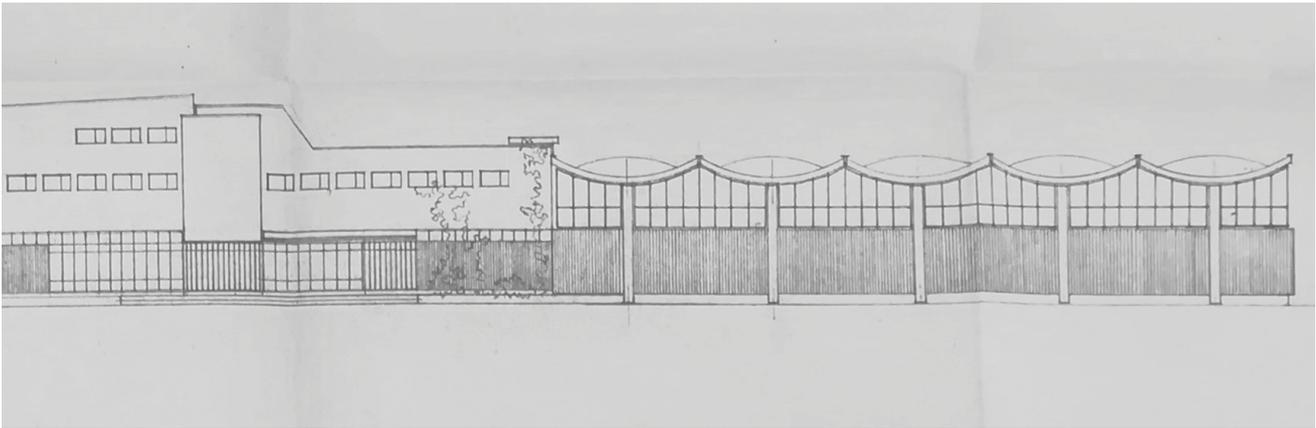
Progetto preliminare per il Mercato dei Fiori, prospetto su via Perugia, arch. Cesare Bersia , *Archivio storico di Torino
